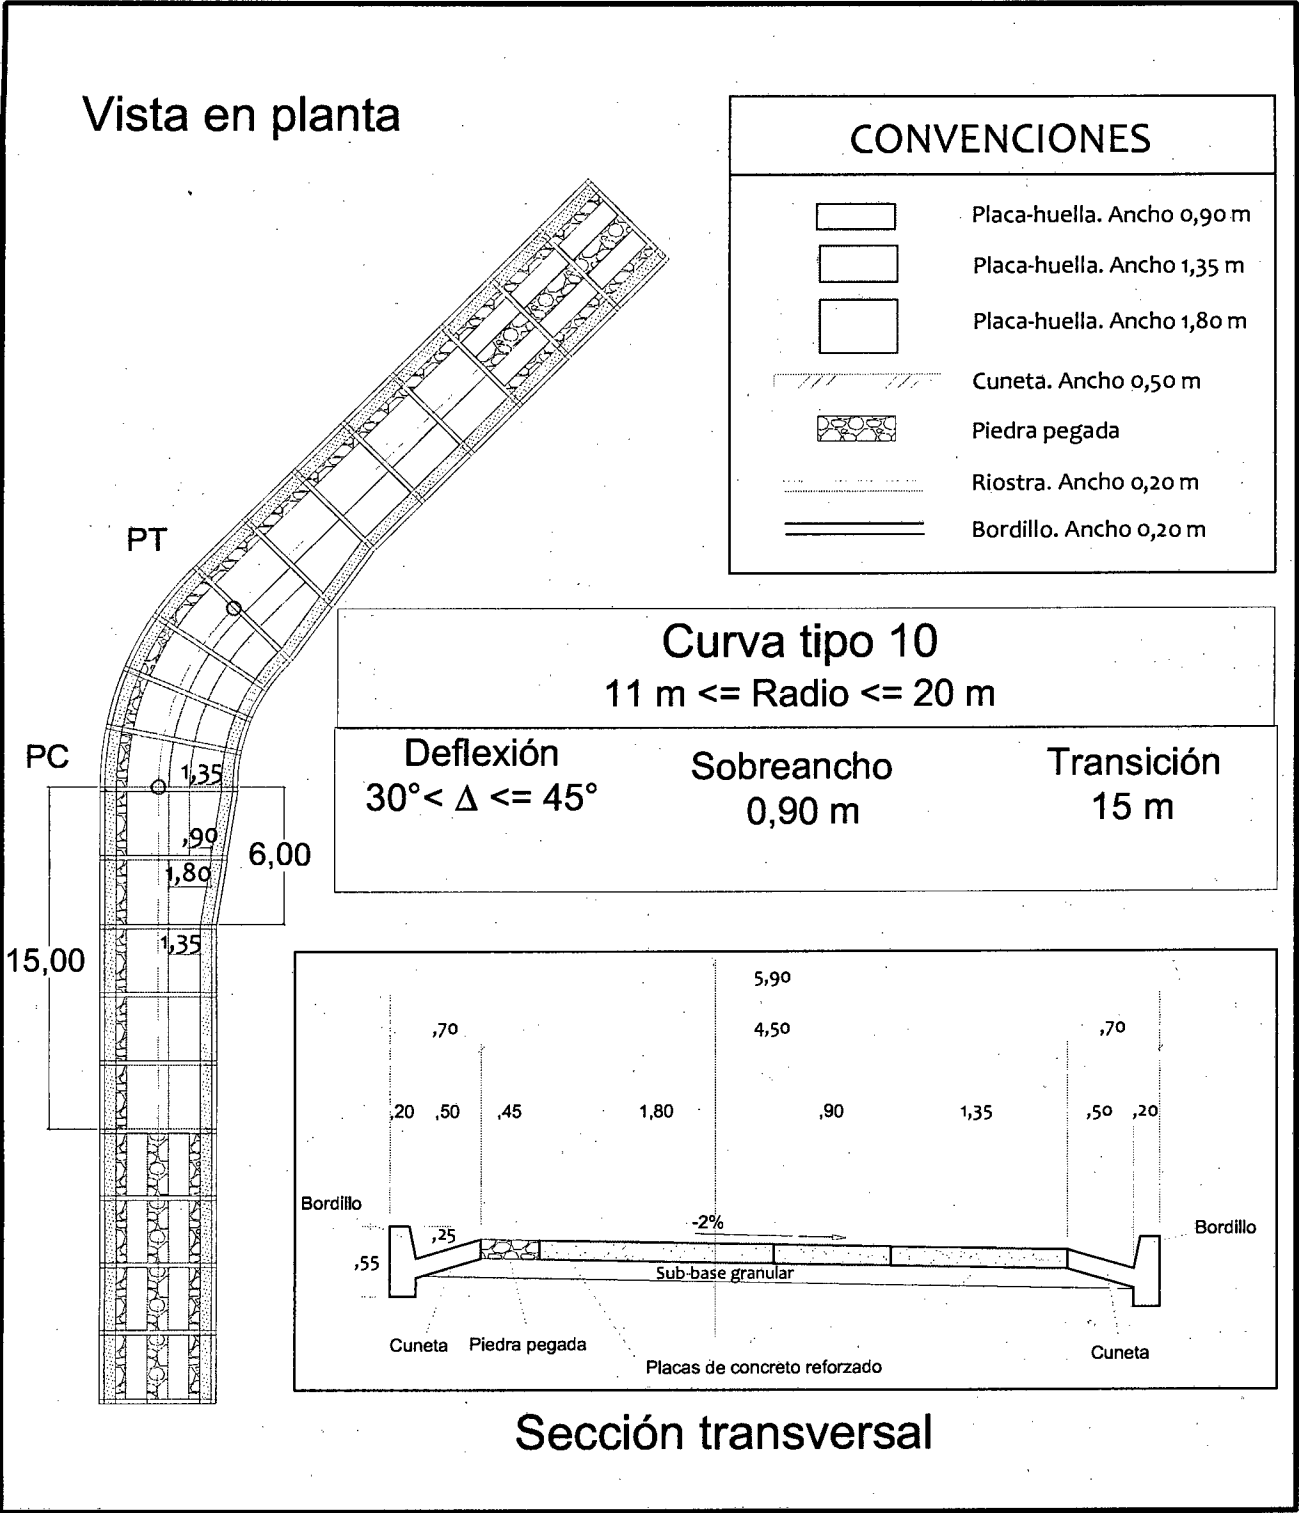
Vista en planta y perfil de la sección transversal en curvas TIPO 10 30° < Δ ≤ 45° y 11 m ≤ Rc ≤ 20 m
